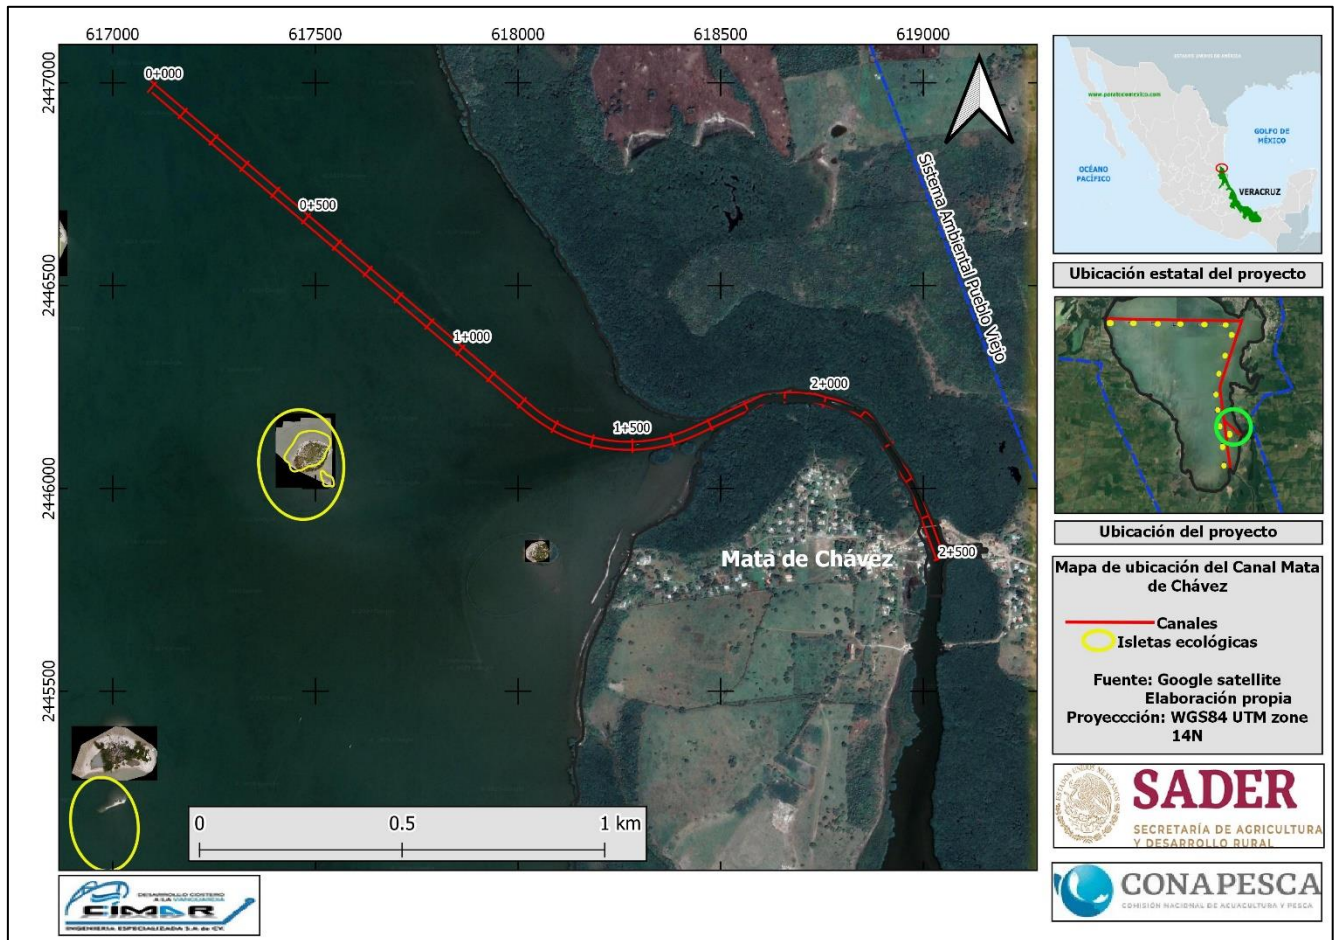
Disposición en planta del Canal de acceso a Mata de Chávez.
